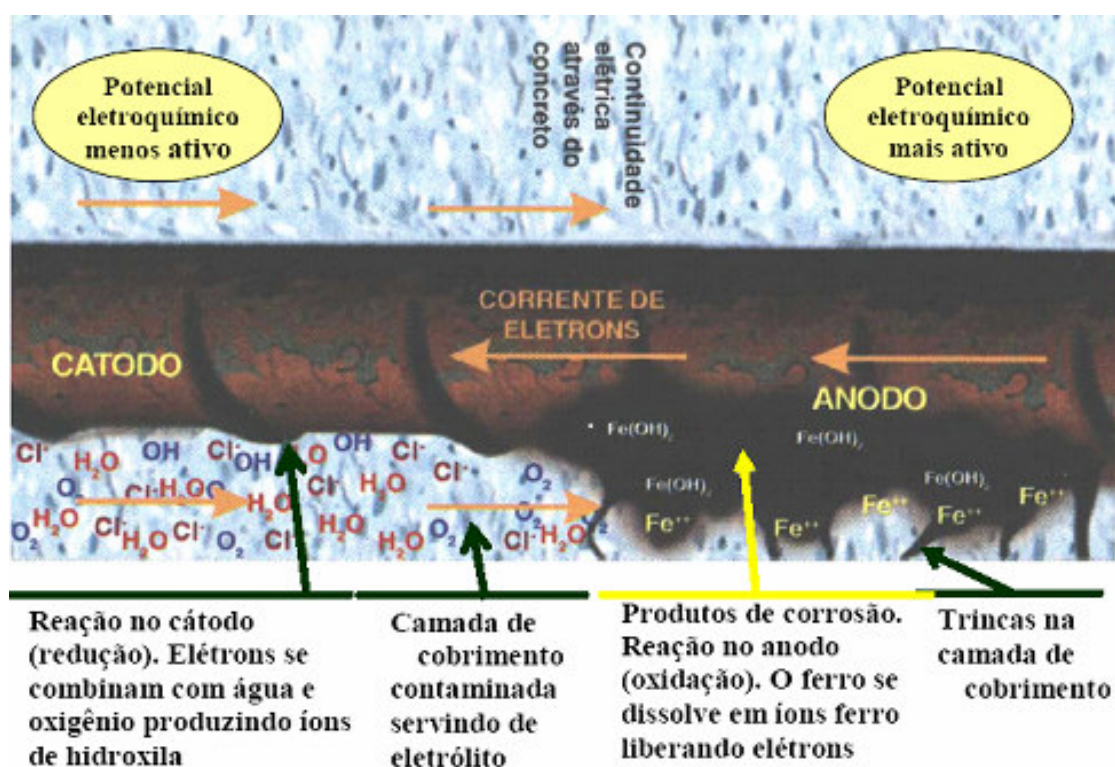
Pilha eletroquímica de corrosão no concreto armado.
